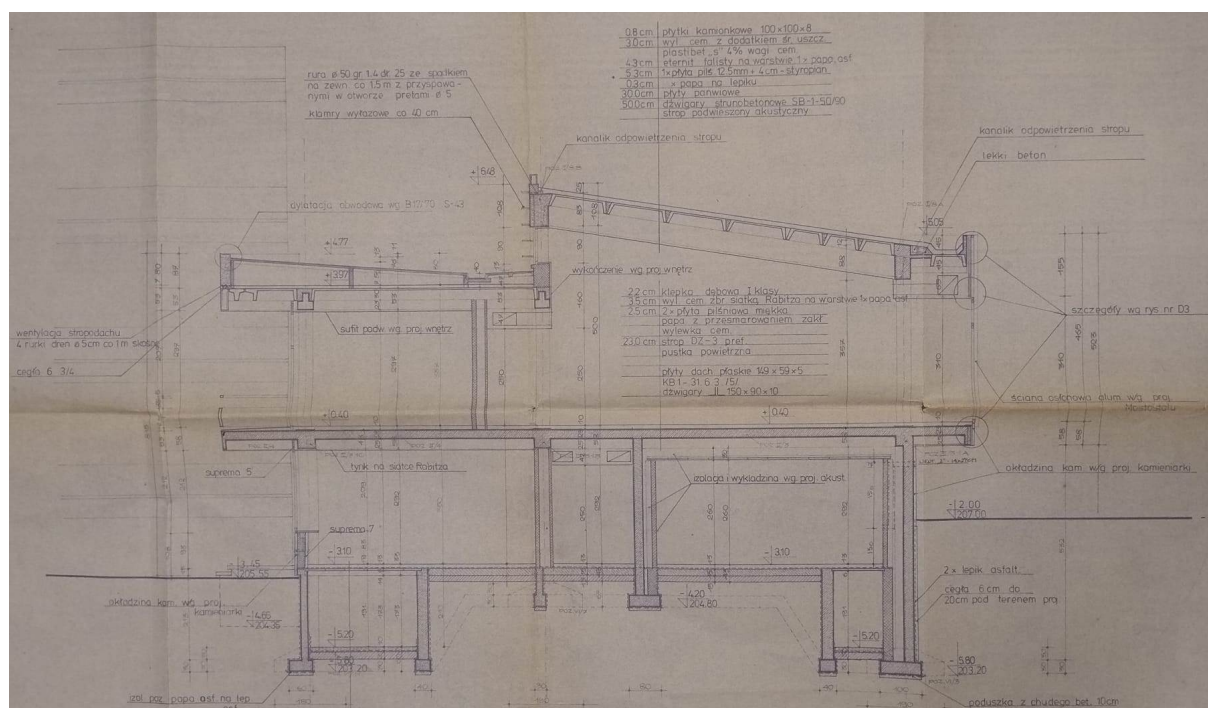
Dźwigary strunobetonowe SB-1-50/9
